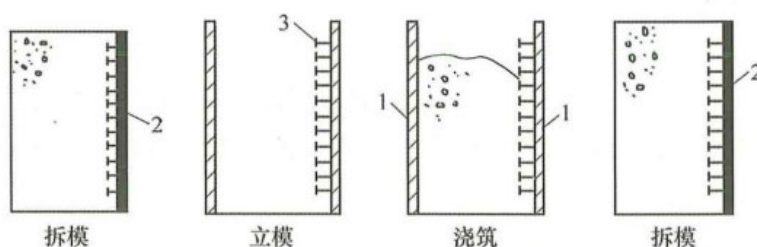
先浇筑混凝土后装填料的填料施工
